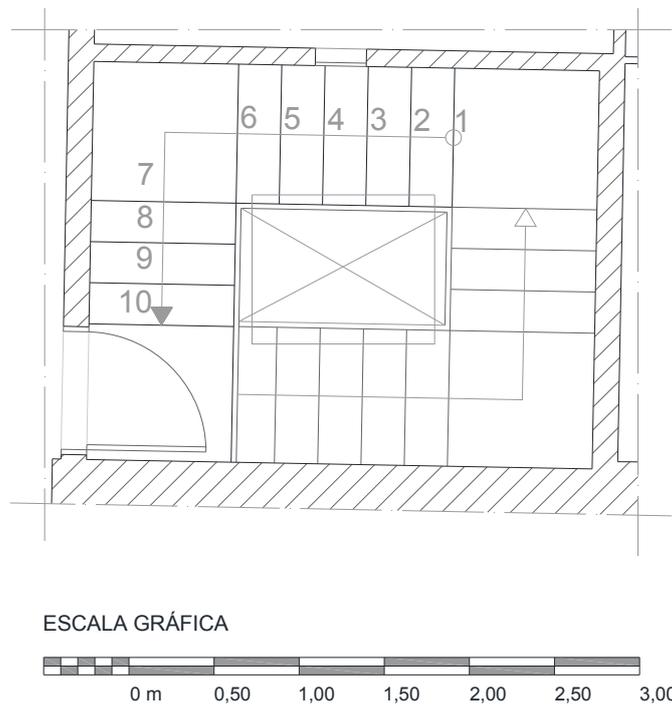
Distribución de la escalera desde planta tercera a bajo-cubierta.
